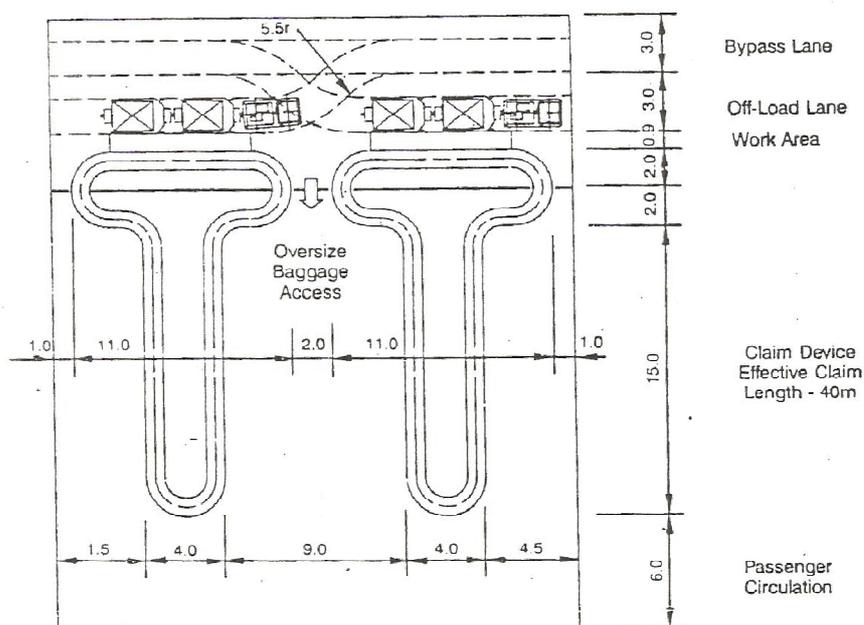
Planta: área de descarga e restituição de bagagem por carrossel rolante – recirculação
